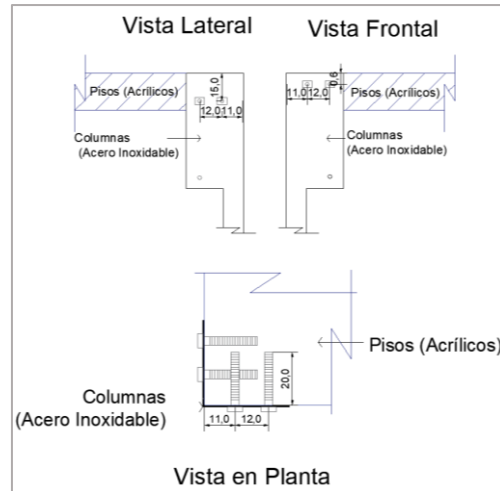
Detalle de conexión (losa - columna), (dimensiones en mm).
